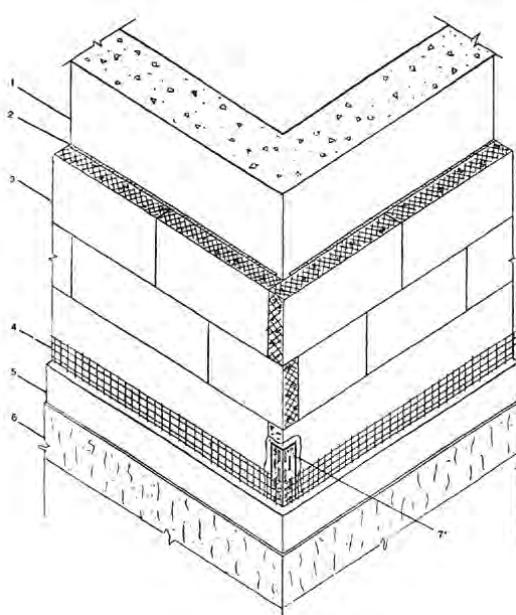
Фрагмент конструктивного решения теплоизоляционного покрытия угловой части фасада здания:
